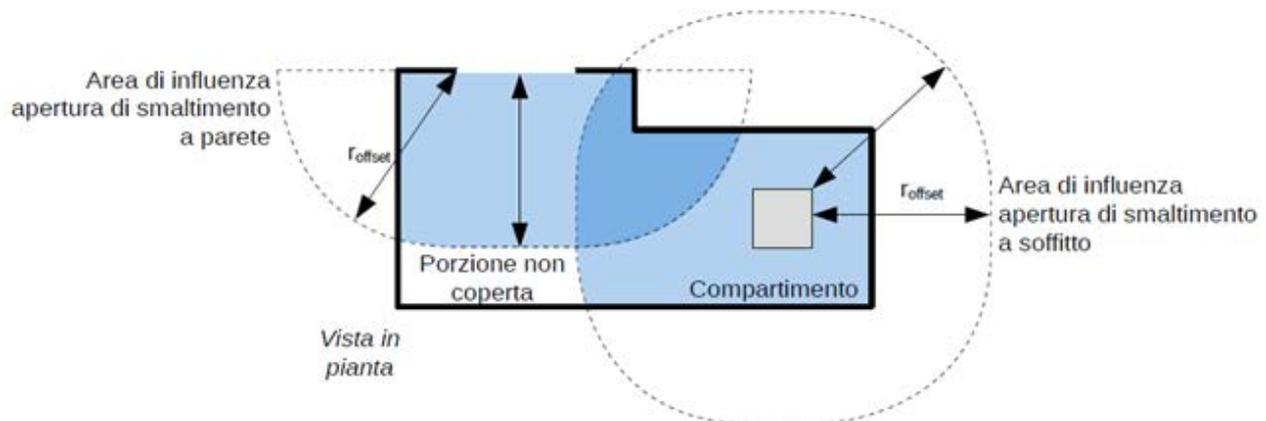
Verifica dell'uniforme distribuzione in pianta delle aperture di smaltimento
